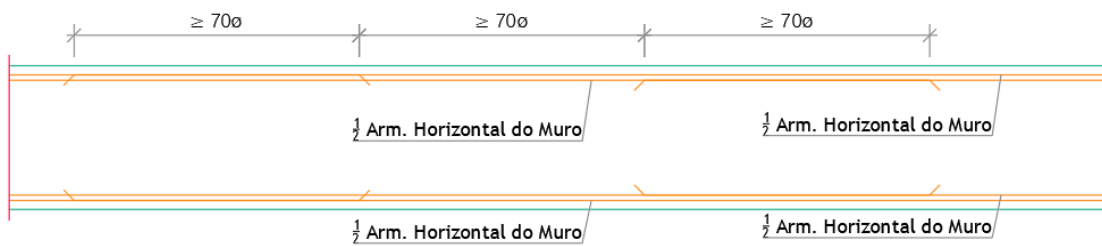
Pormenor da Emenda da Armadura Horizontal dos Muros (Projeto de estruturas).
